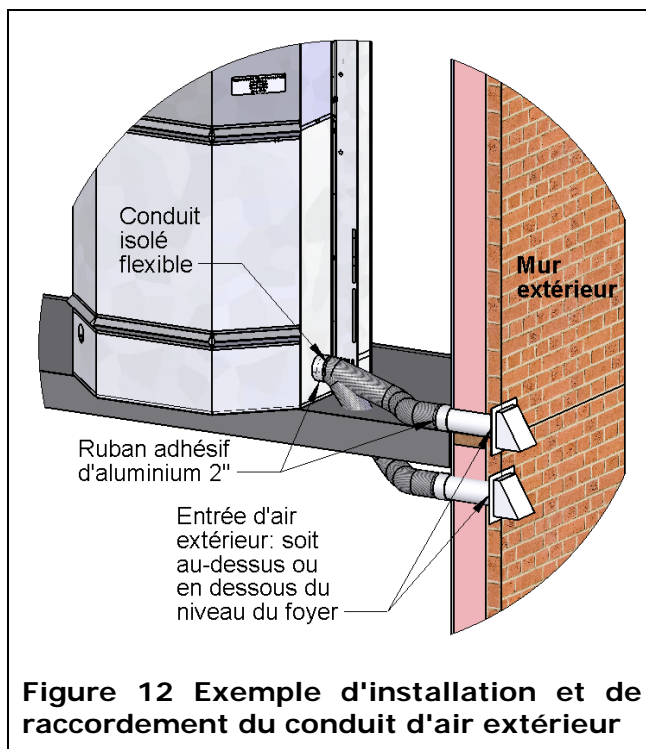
Exemple d'installation et de raccordement du conduit d'air extérieur
